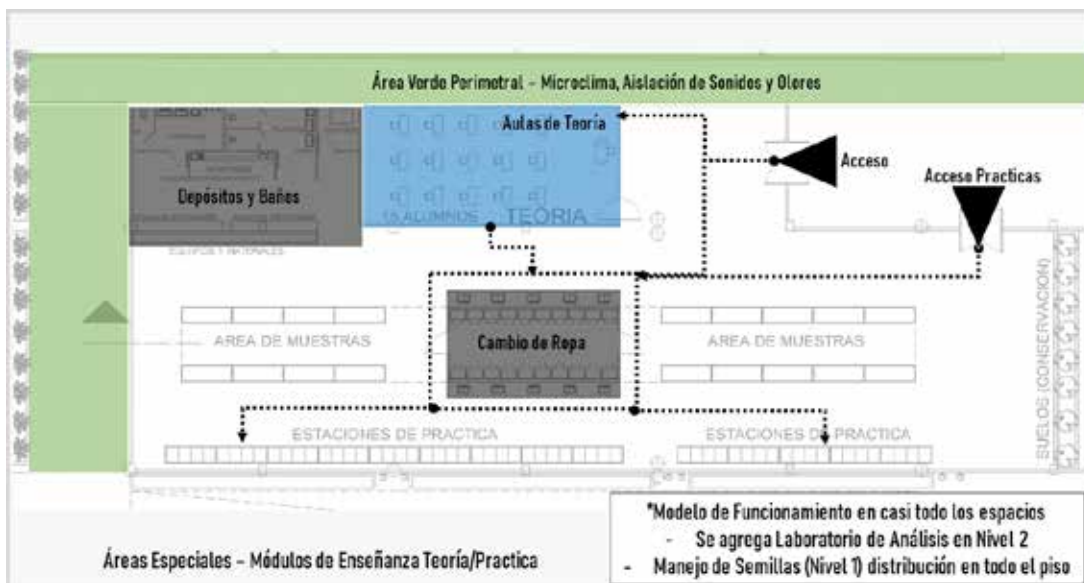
Detalle de Área. Módulo de Enseñanza. Fuente: Schaverin (2021)
